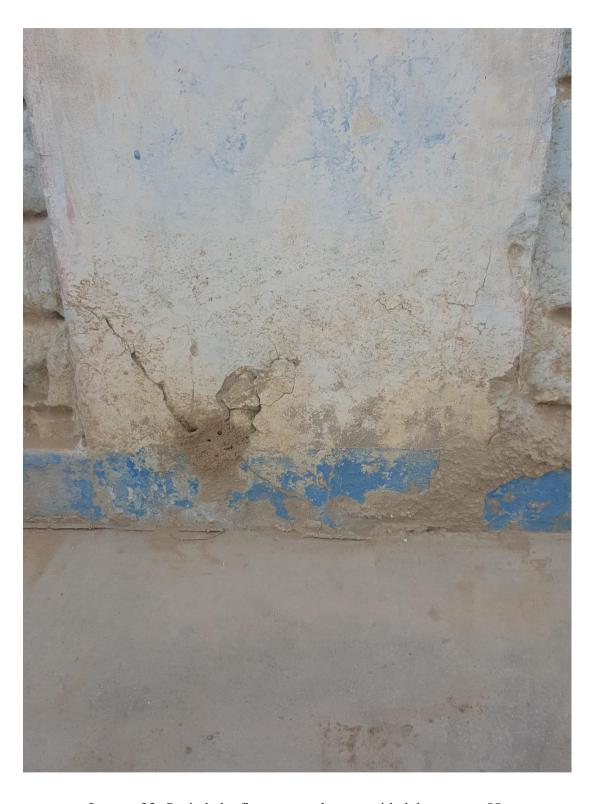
Suciedad y fisuras en columna unidad de muestra 08.
